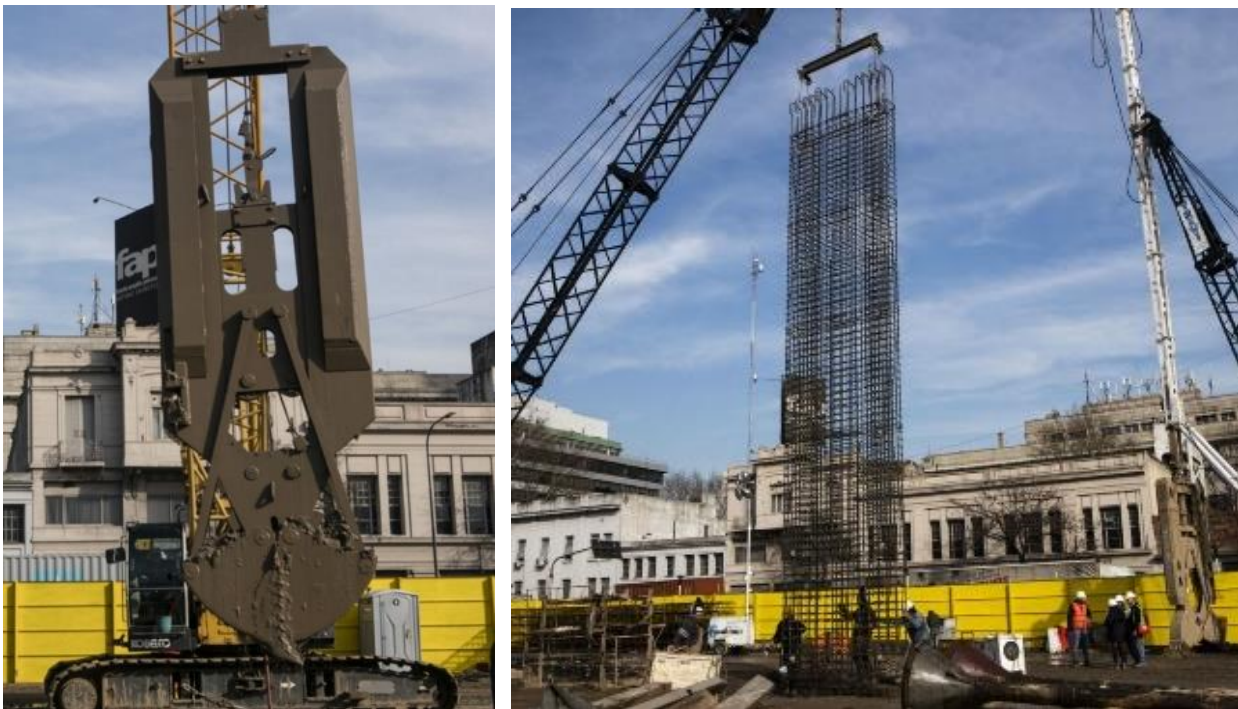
Izq.: Imagen de cuchara para excavación de muro colado. Der.: Armadura
